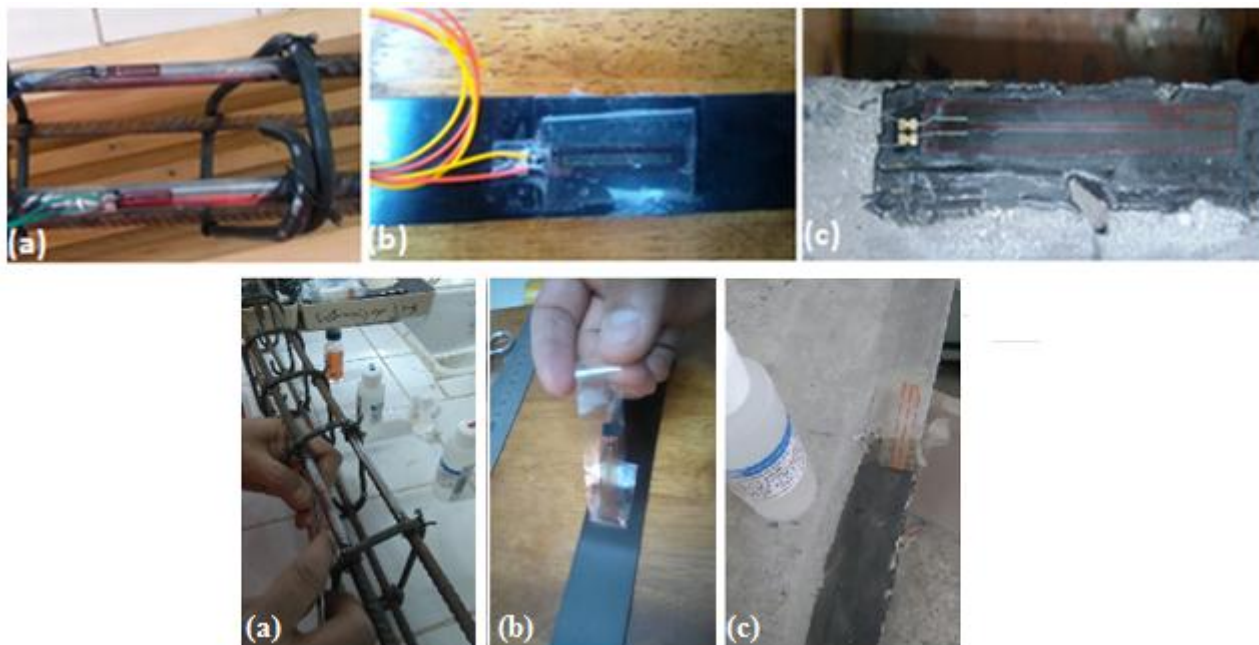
11. Installation des jauges de déformation sur : (a) l'armature, (b) le plats) et (c) le béton.
